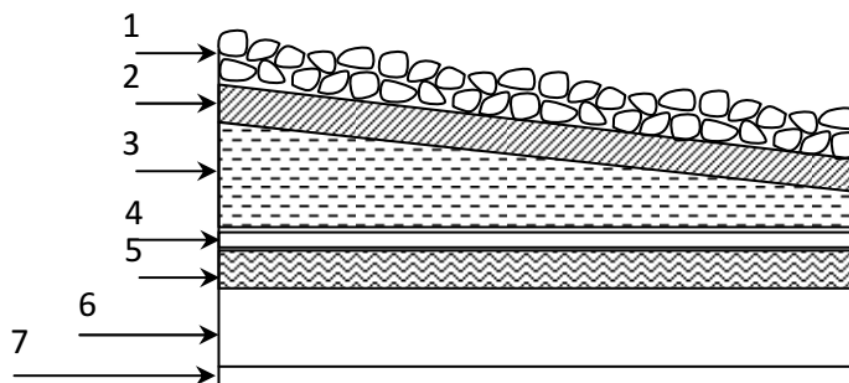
Coupe d'un plancher terrasse (en corps creux). [6]
